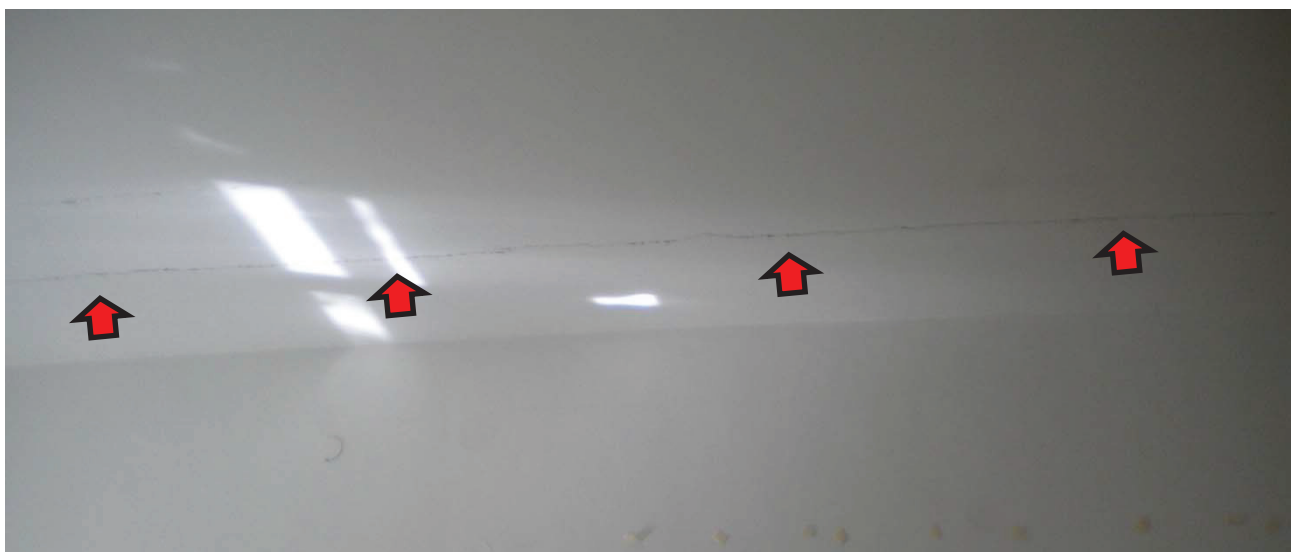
Lezione sul solai di copertura del piano primo
